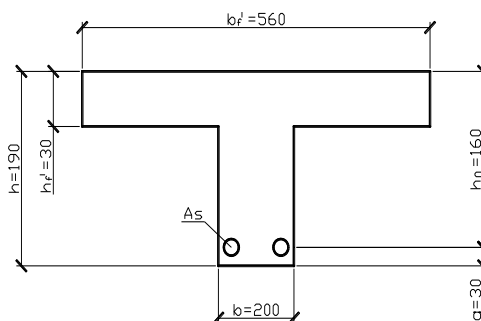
Розрахунковий тавровий переріз збірного залізобетонного сходового маршу
